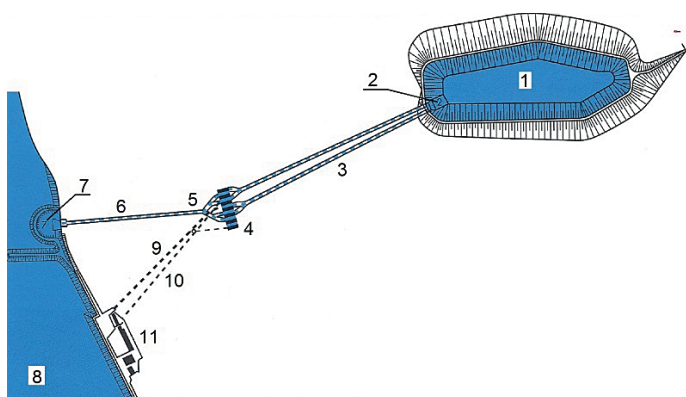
Plan tunelu podwodnego do „Grubej Kaški” w Warszawie [13]
